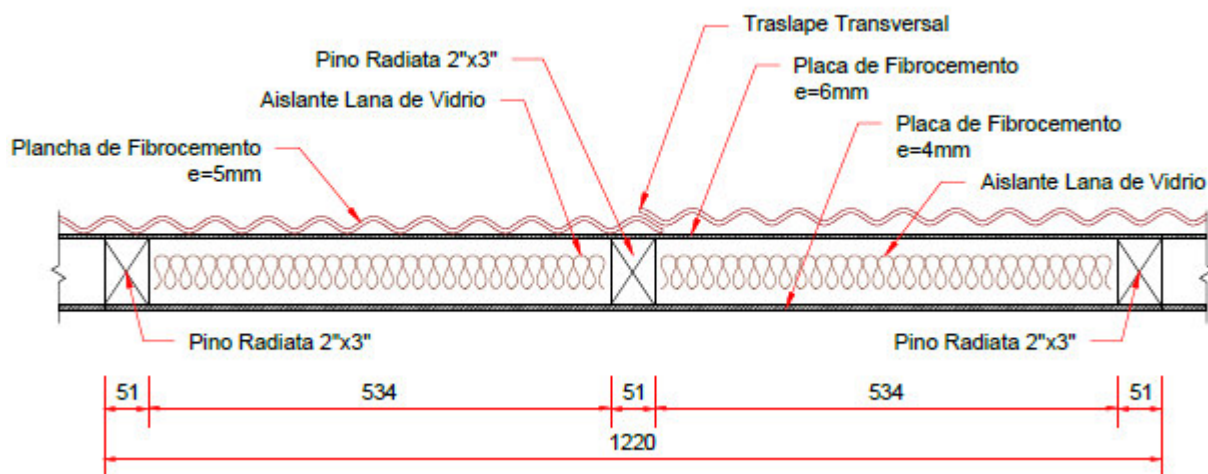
Detalle de panel techo – Sistema de Entramados de Madera
